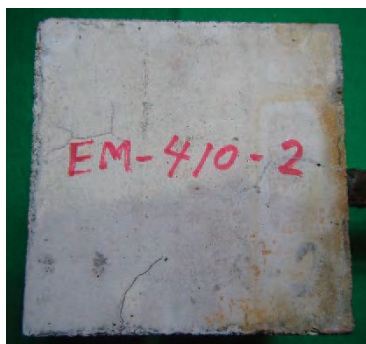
鉄筋露出部の腐食状況 (SUS410)
